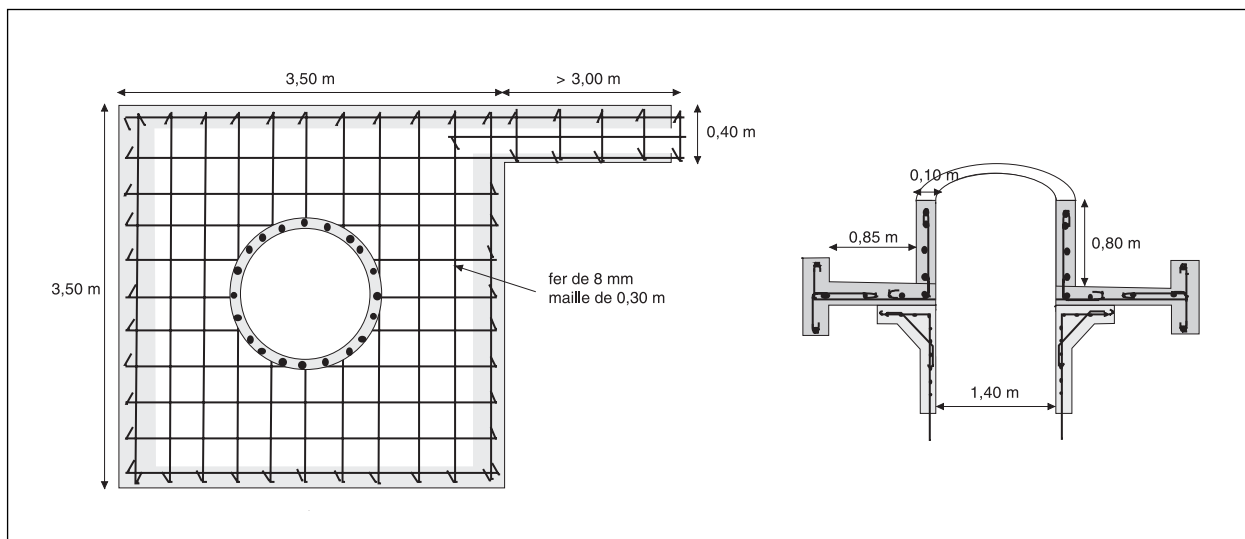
Coupe et vue de dessus de l'aménagement en surface d'un puits.
